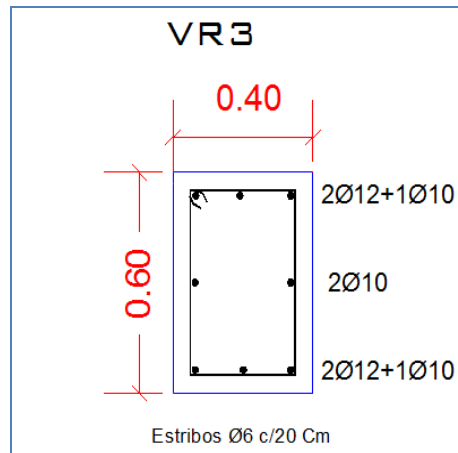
Sección transversal correspondiente a la viga riostra VR3.
